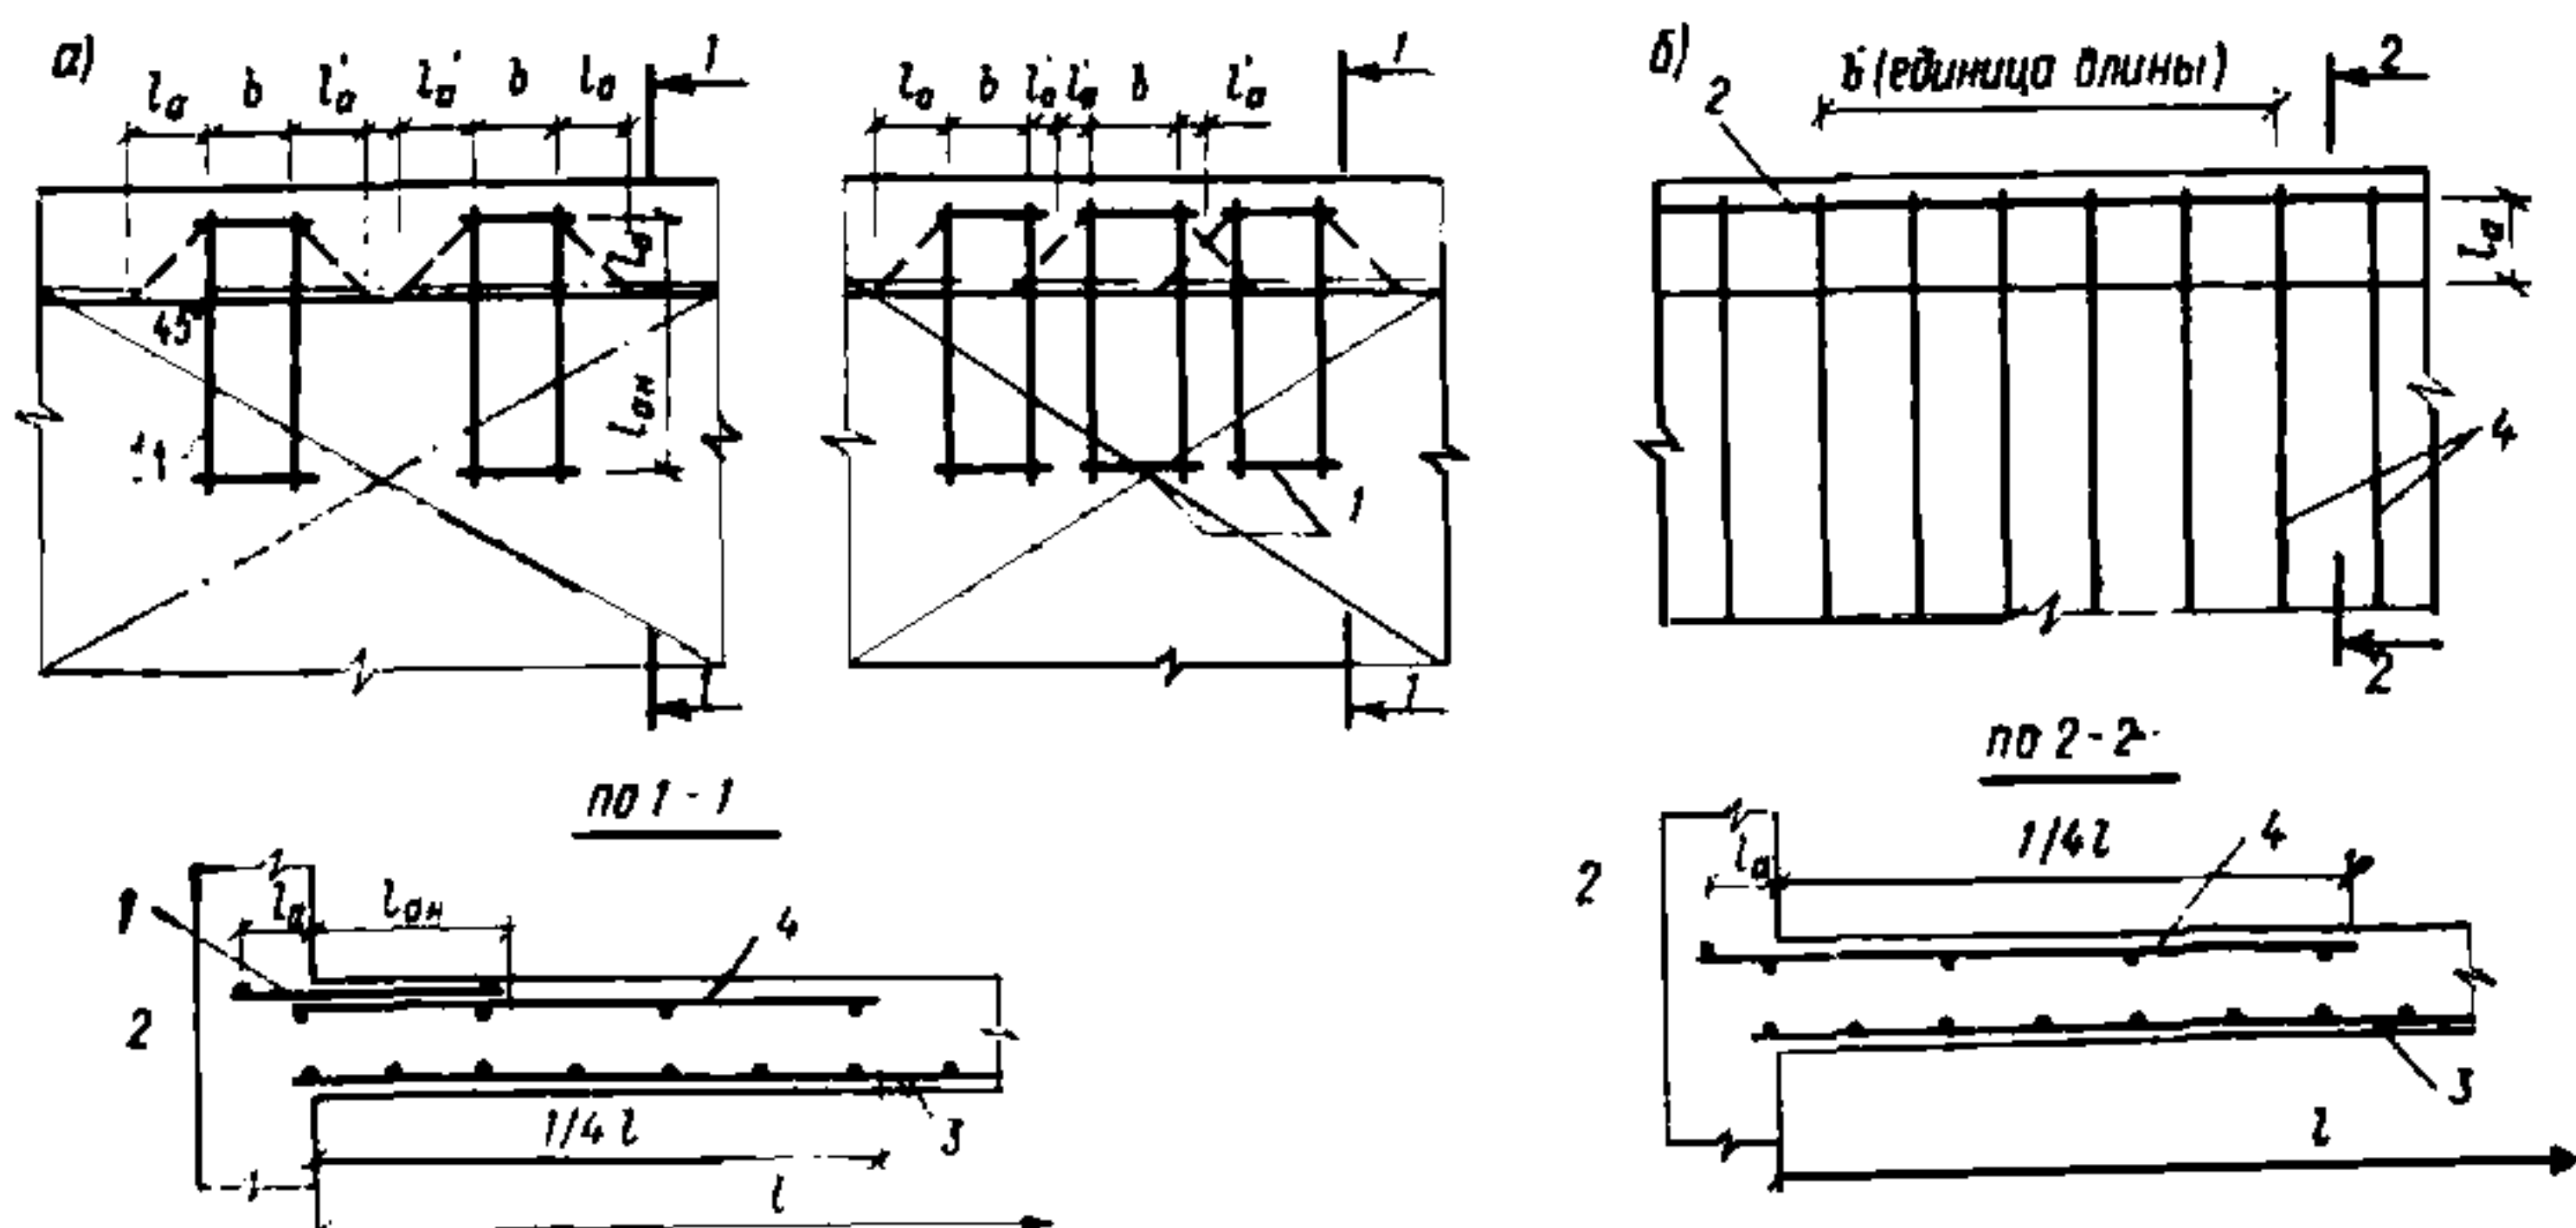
Конструктивные решения сопряжения между монолитными конструкциями плиты перекрытия и торцевой несущей стены
